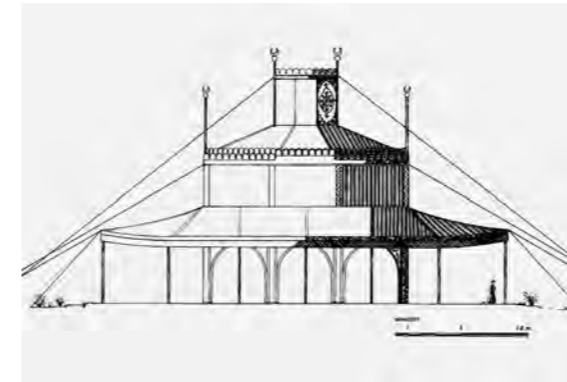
Peter Andrews' Rekonstruktion des Audienzzeltes von Timur nach einer Beschreibung von Ruy González de Clavijo aus dem Jahre 1404. Dieser beschreibt einen quadratischen Grundriss mit zwölf Stützen. Sichtbar sind die vier Eckpfeiler mit den aufgesetzten Mondsicheln. Nach Andrews 1999: 708, Fig. 12 (b).
